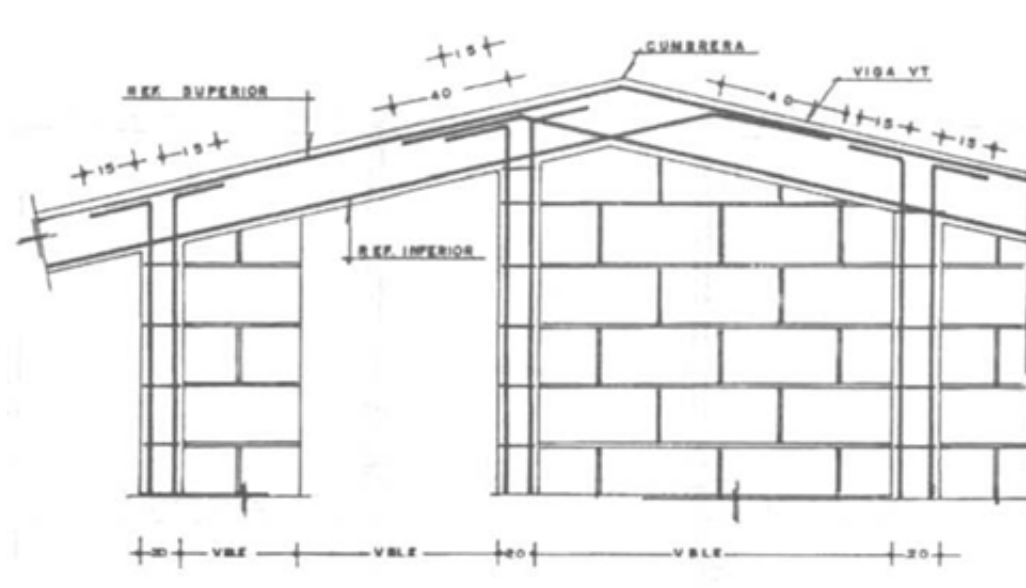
Detalle de las barras de refuerzo longitudinal en distintos sectores de los elementos de confinamiento de un tímpano (SENA, 2003)
